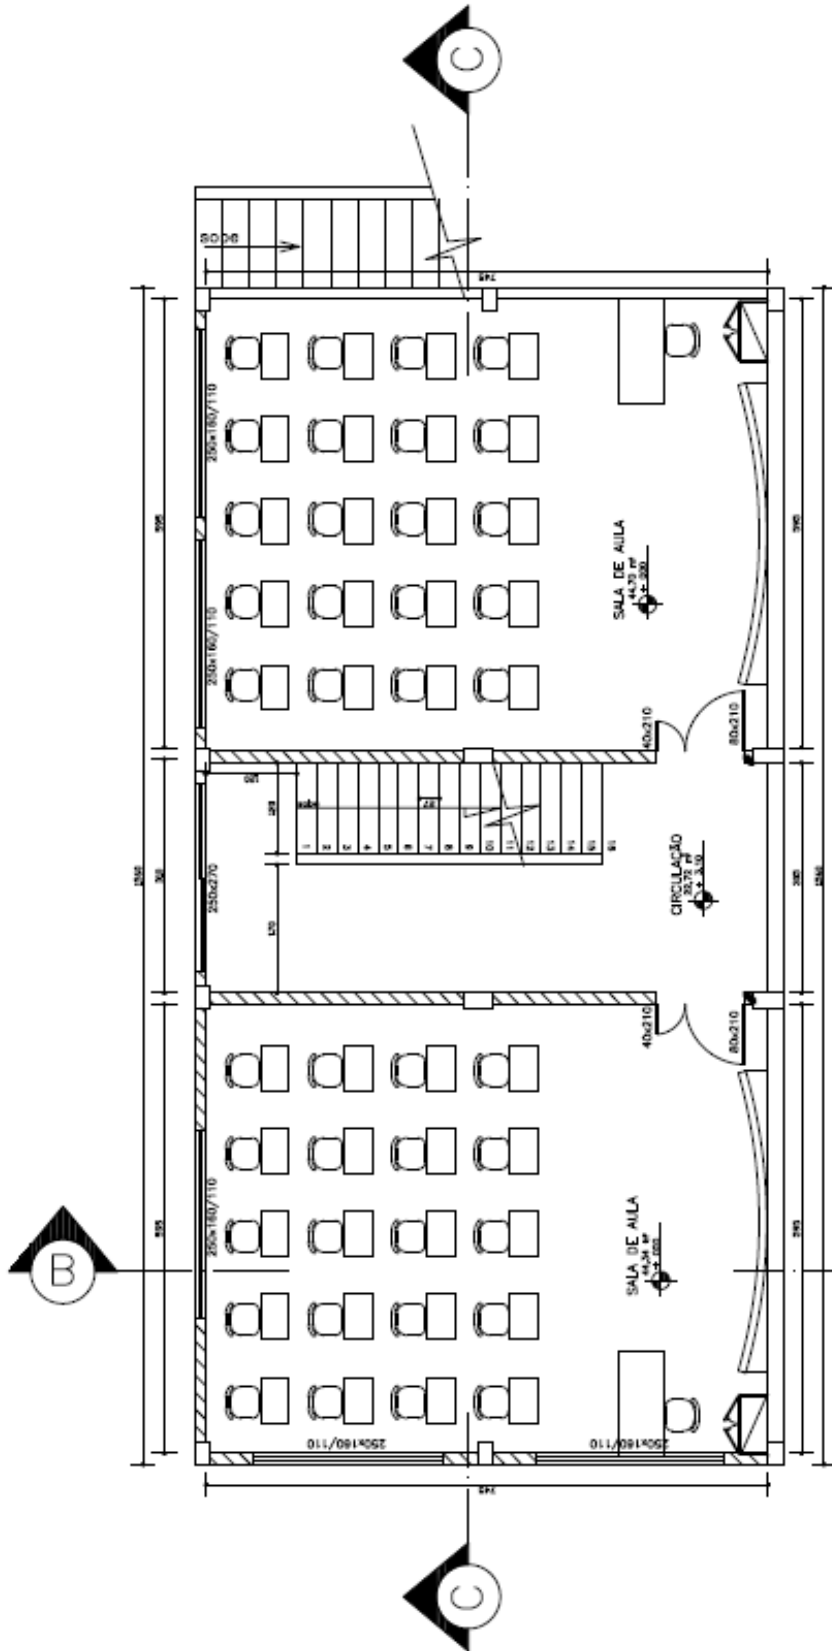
Planta baixa - segundo pavimento - ESCOLA 1
